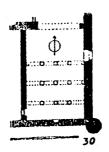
مسقط أفقي للجامع الأقصي في عهد الخليفة العباسي المهدي (عن ، كريزول) .
